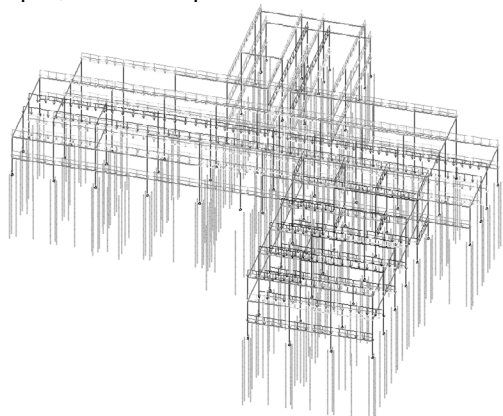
Расчетная схема каркасного здания на свайном основании (грунт основания не показан)
